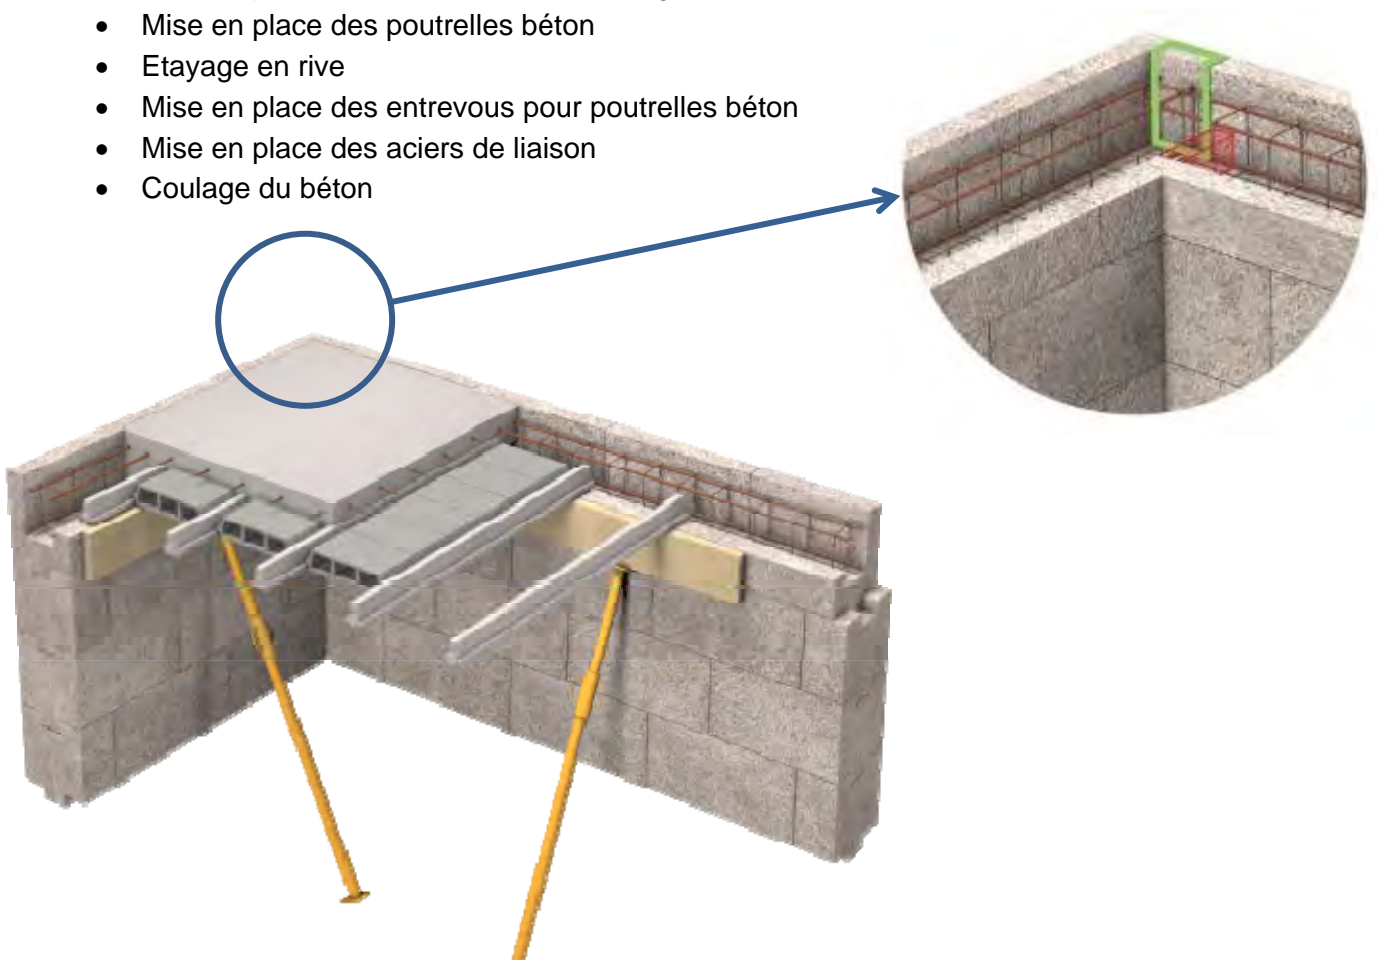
vue d'ensemble de la mise en œuvre d'un plancher béton de type poutrelles/hourdis
